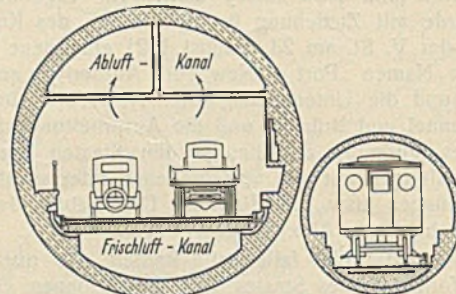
Querschnitt des Holland-Tunnels und einer Untergrundbahn unter dem Hudson.
